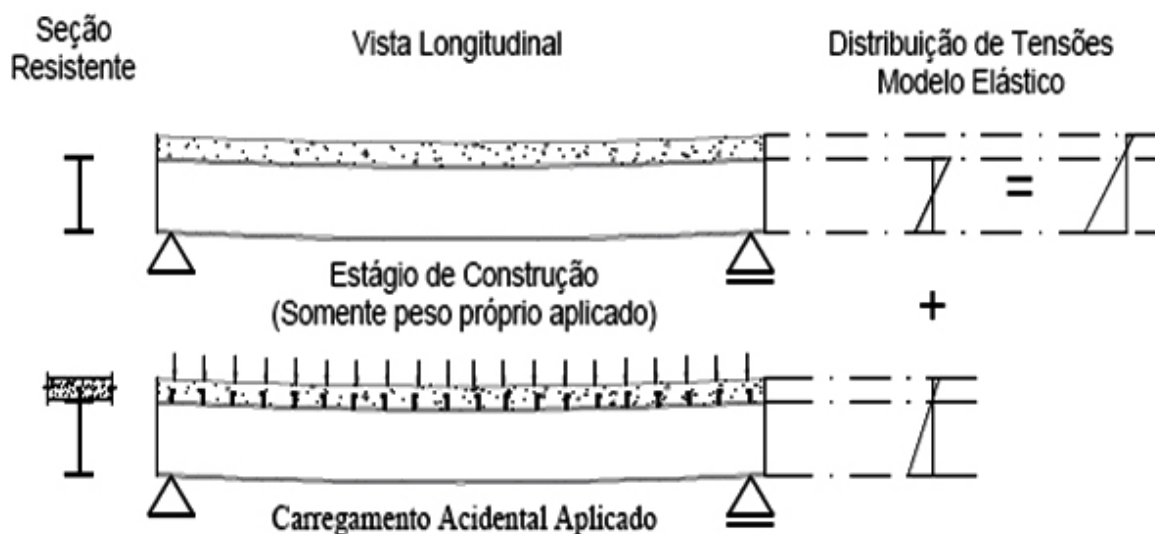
VIGAS MISTAS NÃO ESCORADAS
